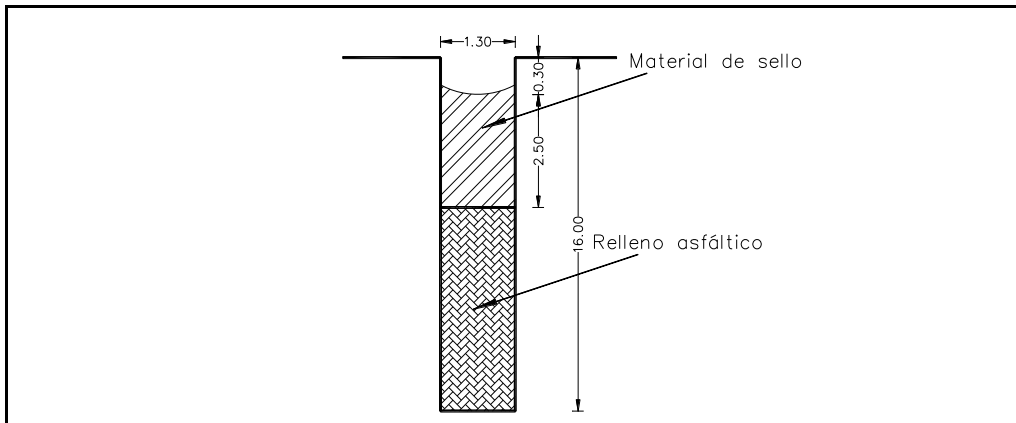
Detalle de Juntas de Expansión en el Pavimento
